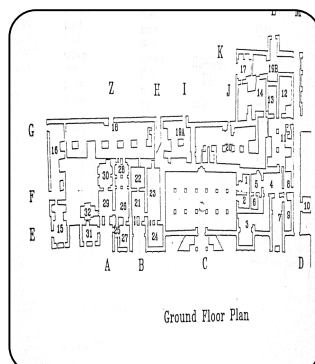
مسقط أفقي للدور الأرضي لمصنع الكسوة
